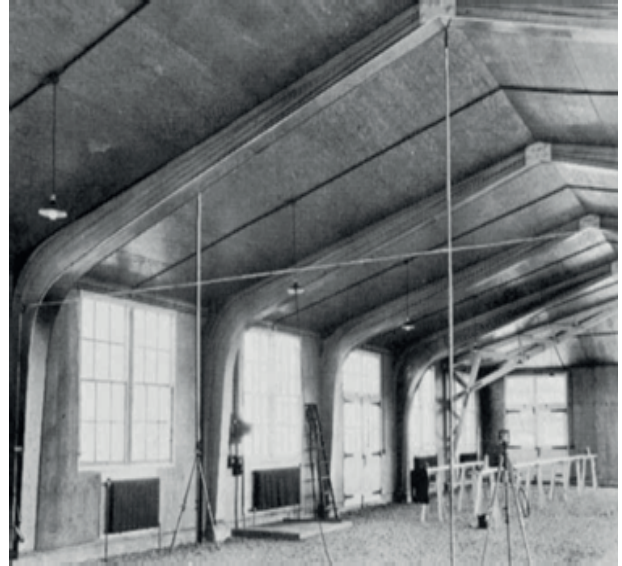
Interior del edificio Forest Products Lab en construcción.
